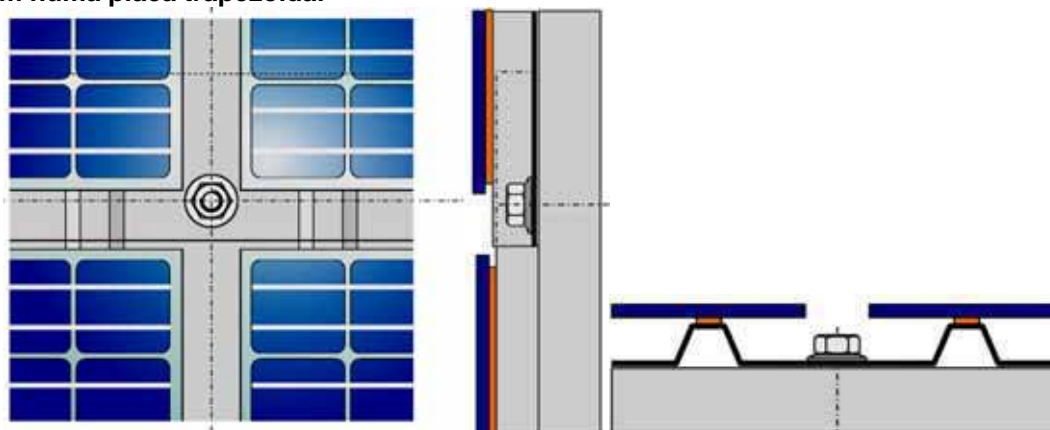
Plano superior e secções de corte transversal e longitudinal
